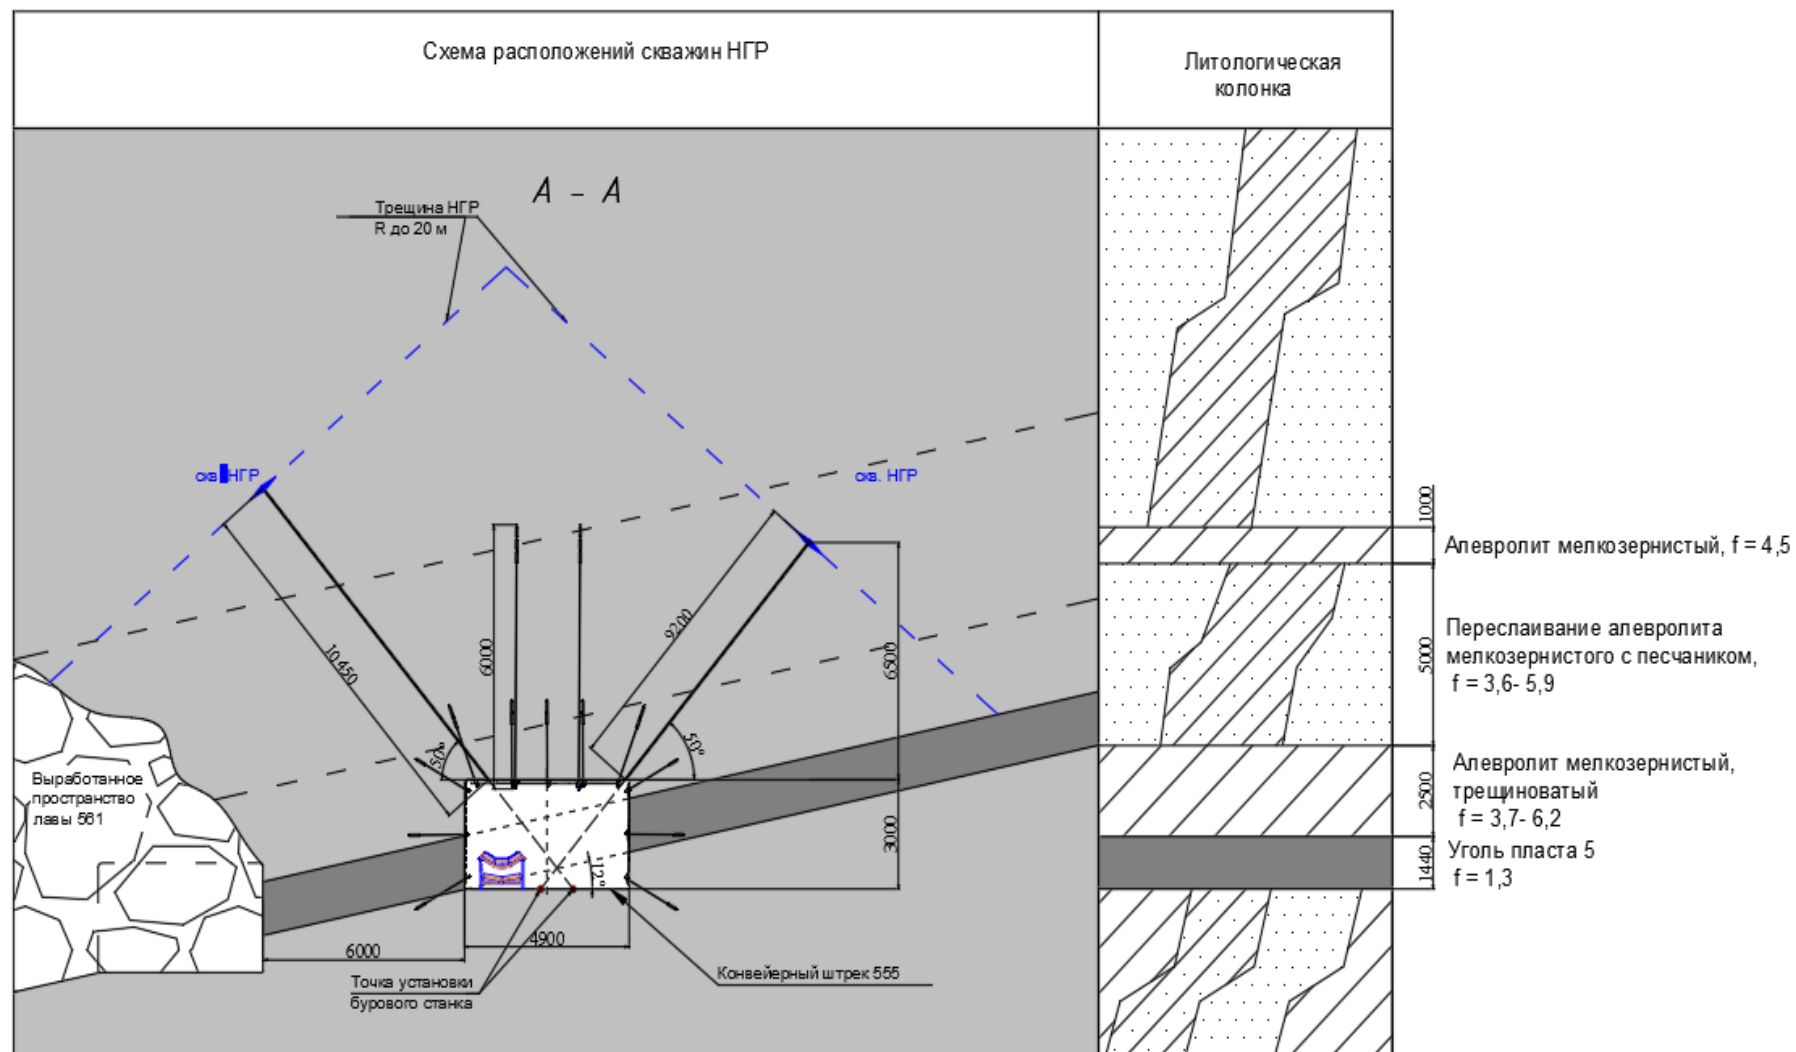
Схема расположения скважин НГР из конвейерного штрёка 555 (Вид А-А)
